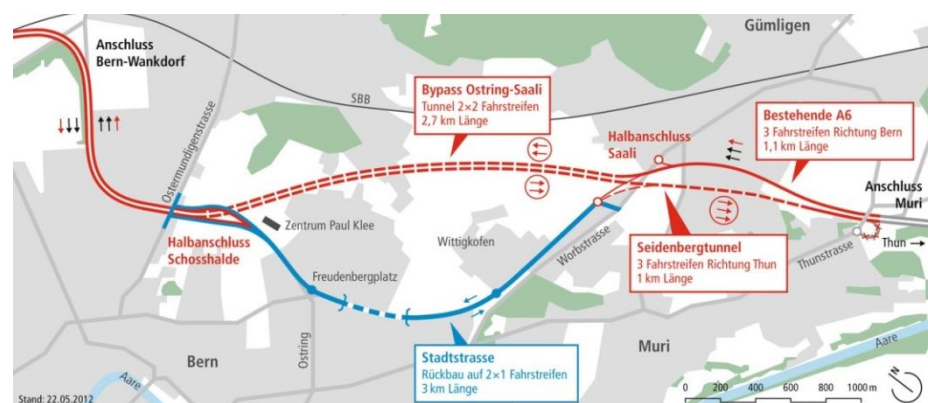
Variante B6: Bypass Ostring / einröhriger Seidenbergtunnel (Quelle: Bundesamt für Strassen)
